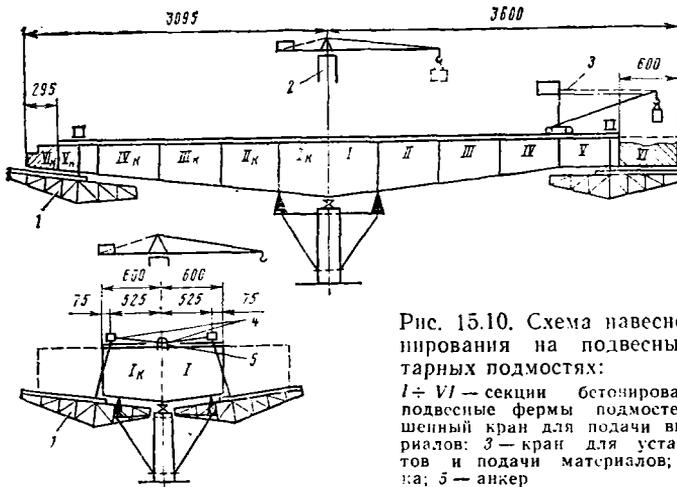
Схема навесного бетонирования на подвесных инвентарных подмостях:
